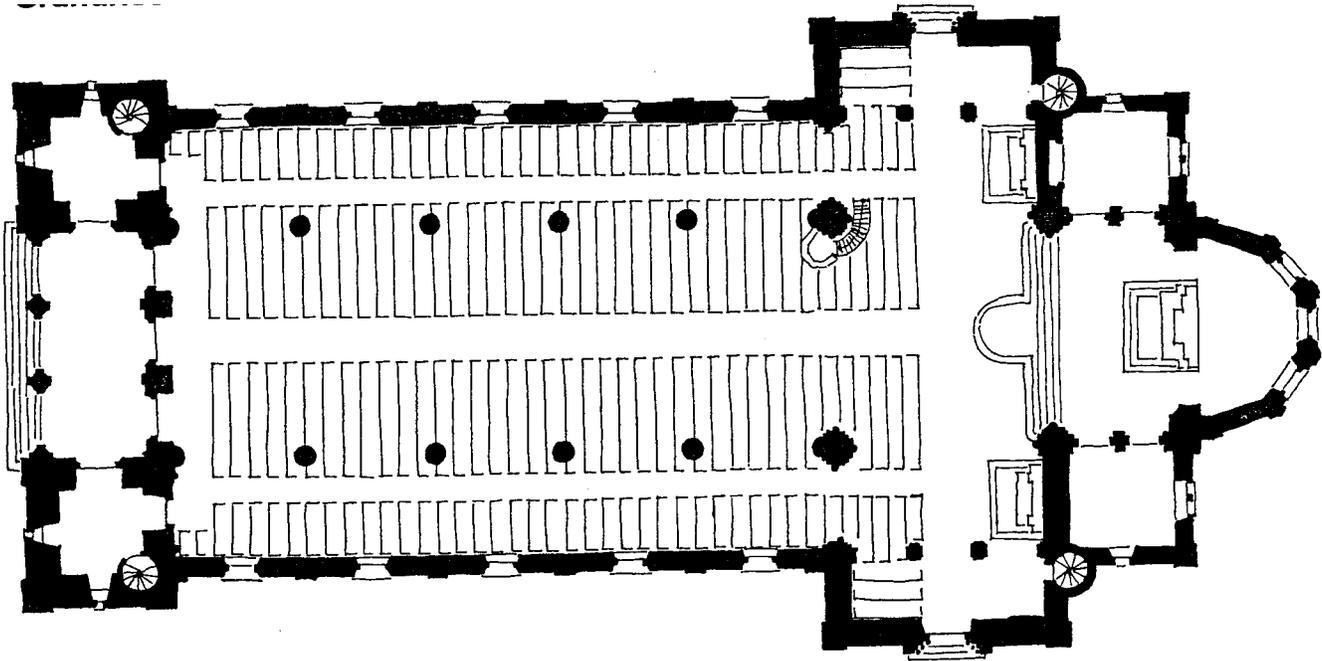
Grundriss evangelische Kirche Glarus
